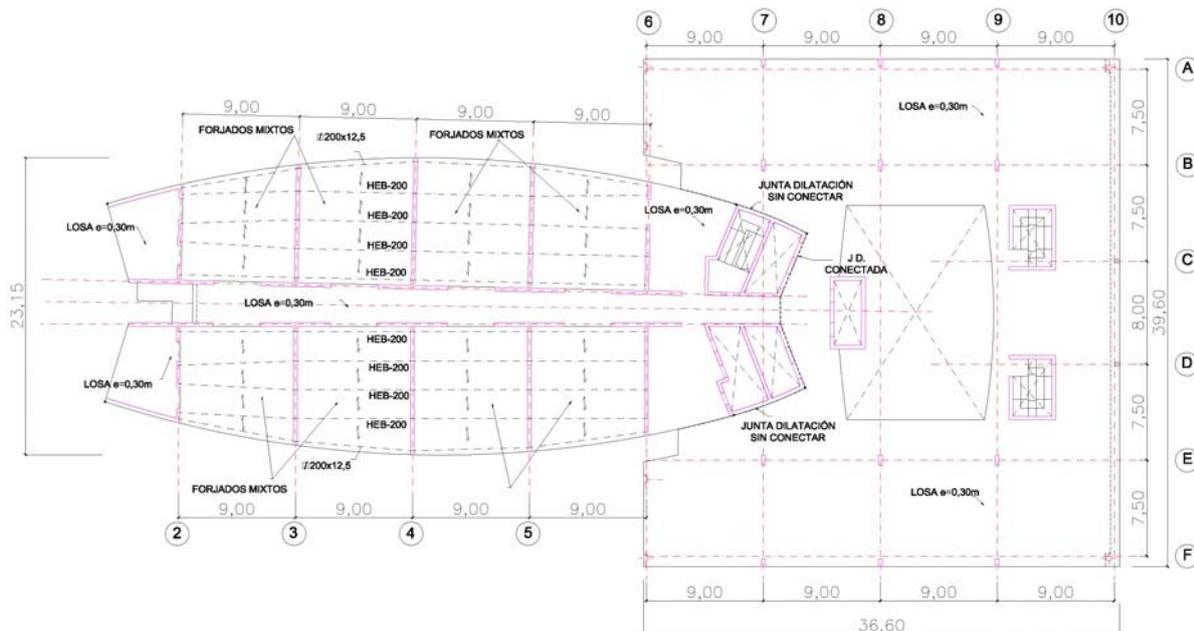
Planta tipo entre P-1 y P-7 con los edificios Torre y Atrio del Hotel Vela
